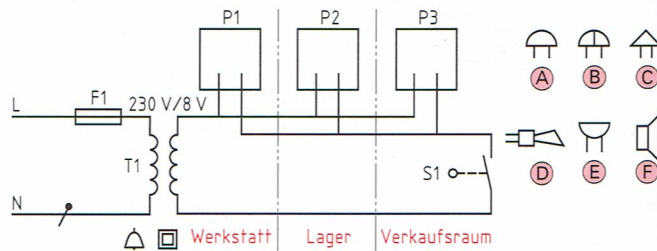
Klingelanlage für einen Verkaufsraum mit Lager und Werkstatt
